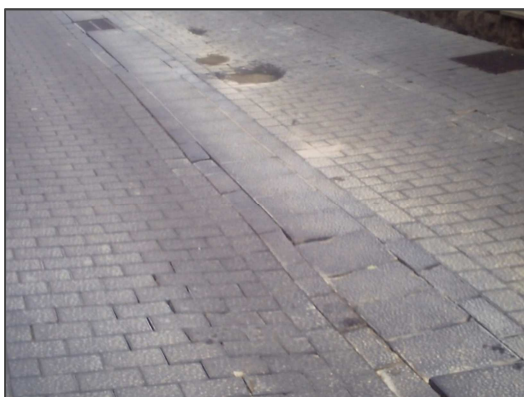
Estado del pavimento en c/ Escoles Pies.
